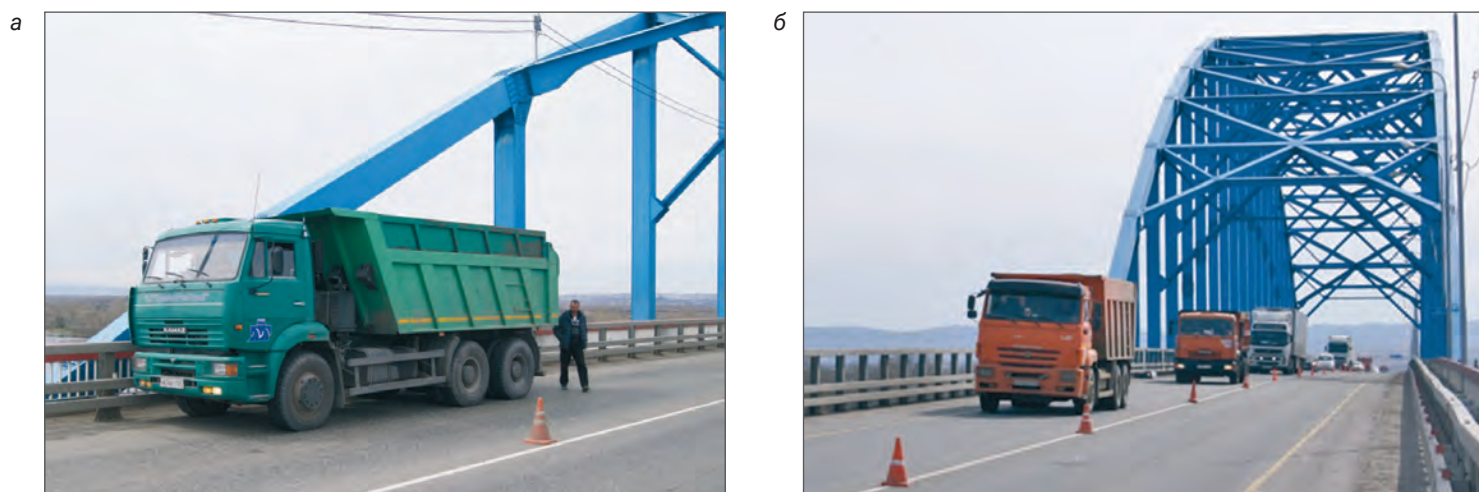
Испытательная нагрузка на мосту: а — статические испытания; б — динамические испытания (проезд обращающейся нагрузки)
